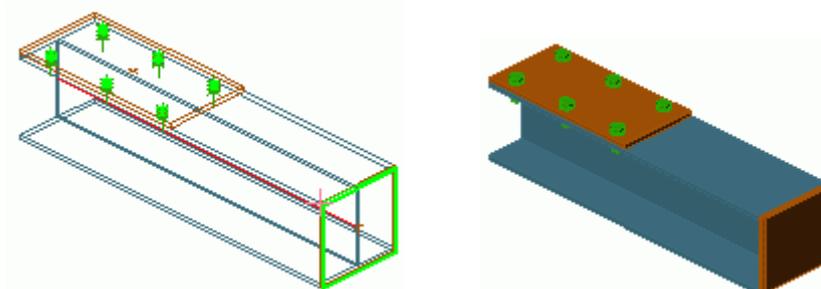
Schraubenbild, Schweißnahtpunkt
